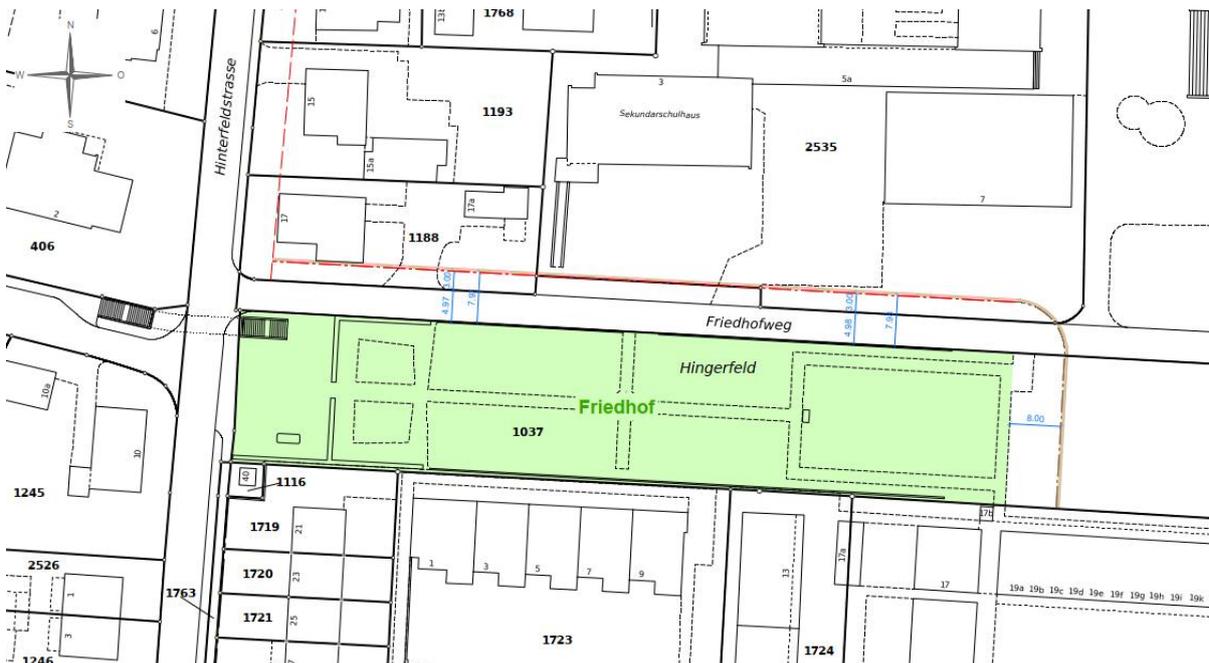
Friedhofsbaulinienplan (Quelle: Mutationsplan)
